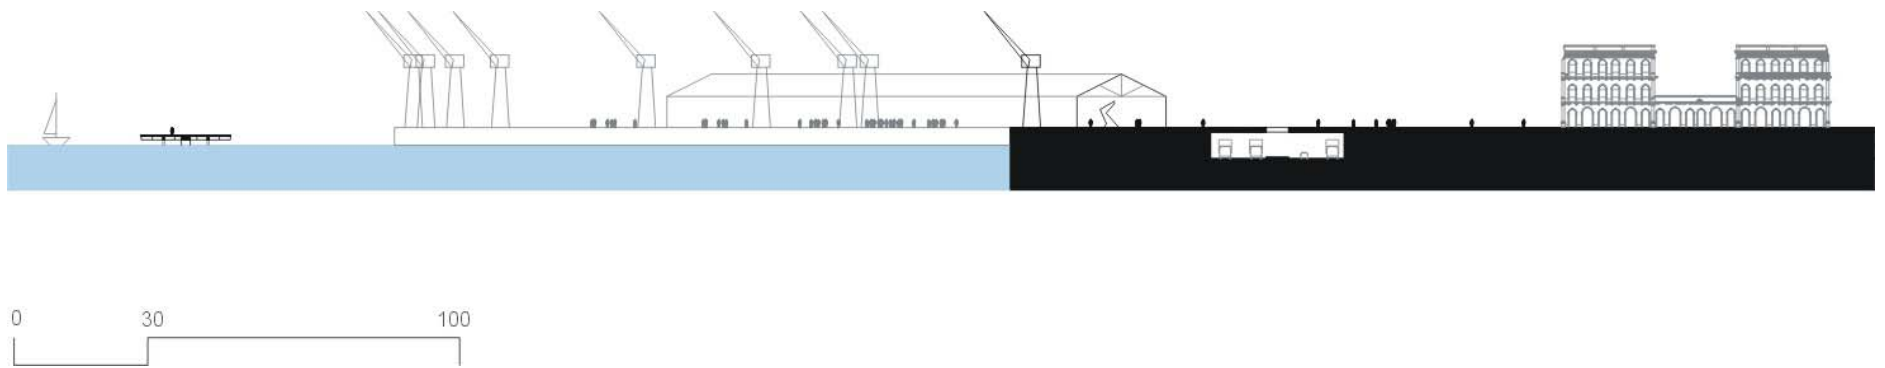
Corte Longitudinal do Largo (Casarões), esplanada de contemplação, avenida rebaixada, armazéns e marina. Desenho do autor.
